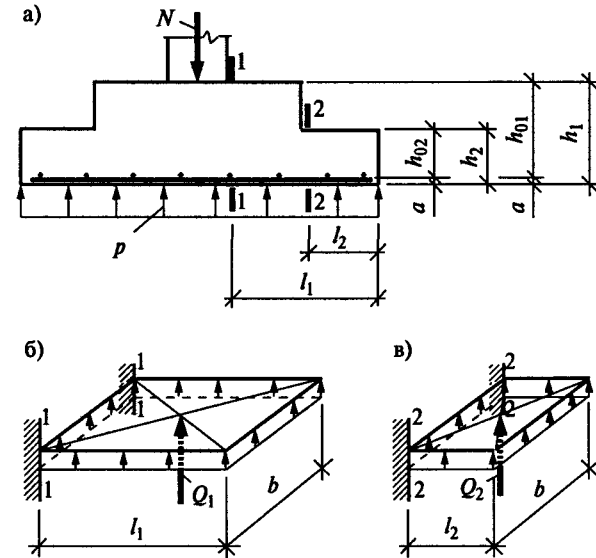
К расчету арматуры фундамента: а) расчетные сечения фундамента; б) часть подошвы фундамента, отсеченная сечением 1–1; в) то же сечением 2–2
